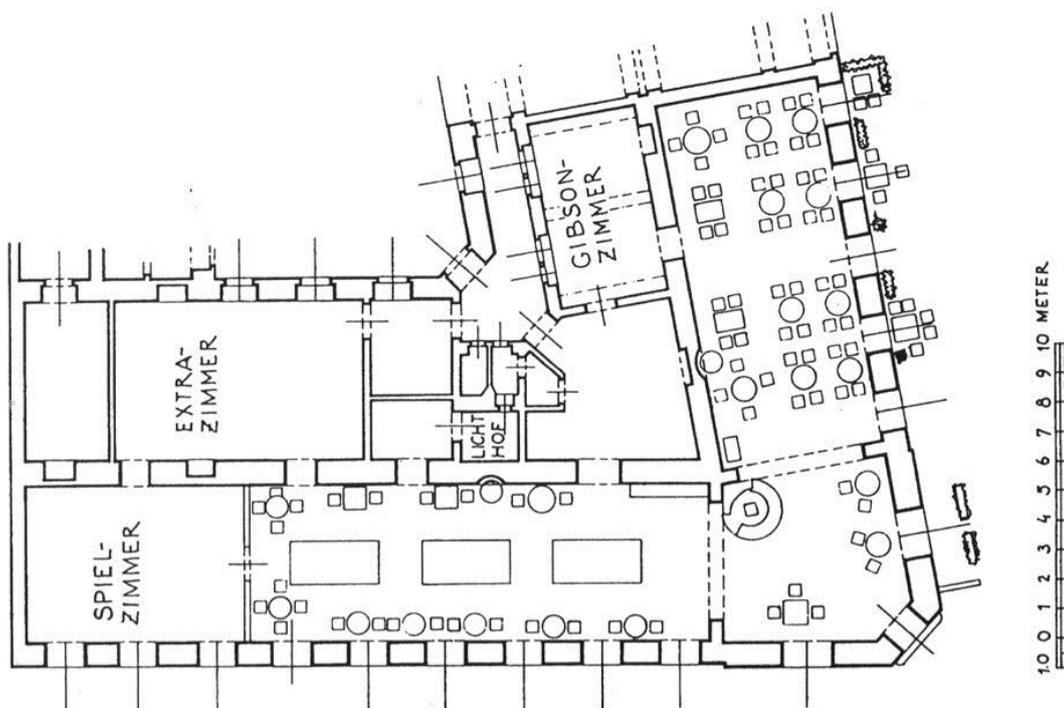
o. Ersteller: Grundriss Café Museum, Planrekonstruktion, 1981, Archiv Rukschcio/Schachel
